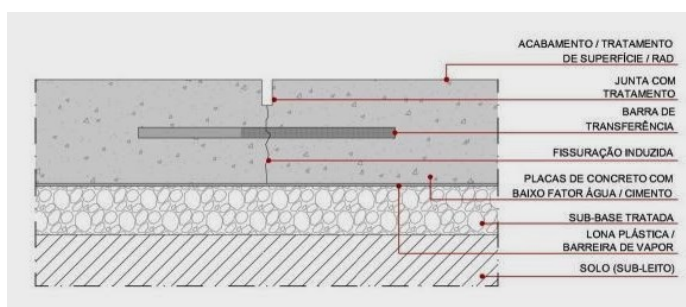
Seção de pavimento de concreto simples com barra de transferência
